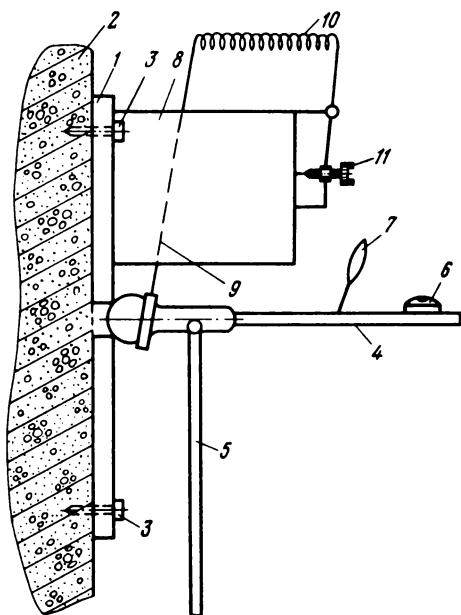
Схема осадочной марки с узлом крепления (усовершенствованный вариант [1])
